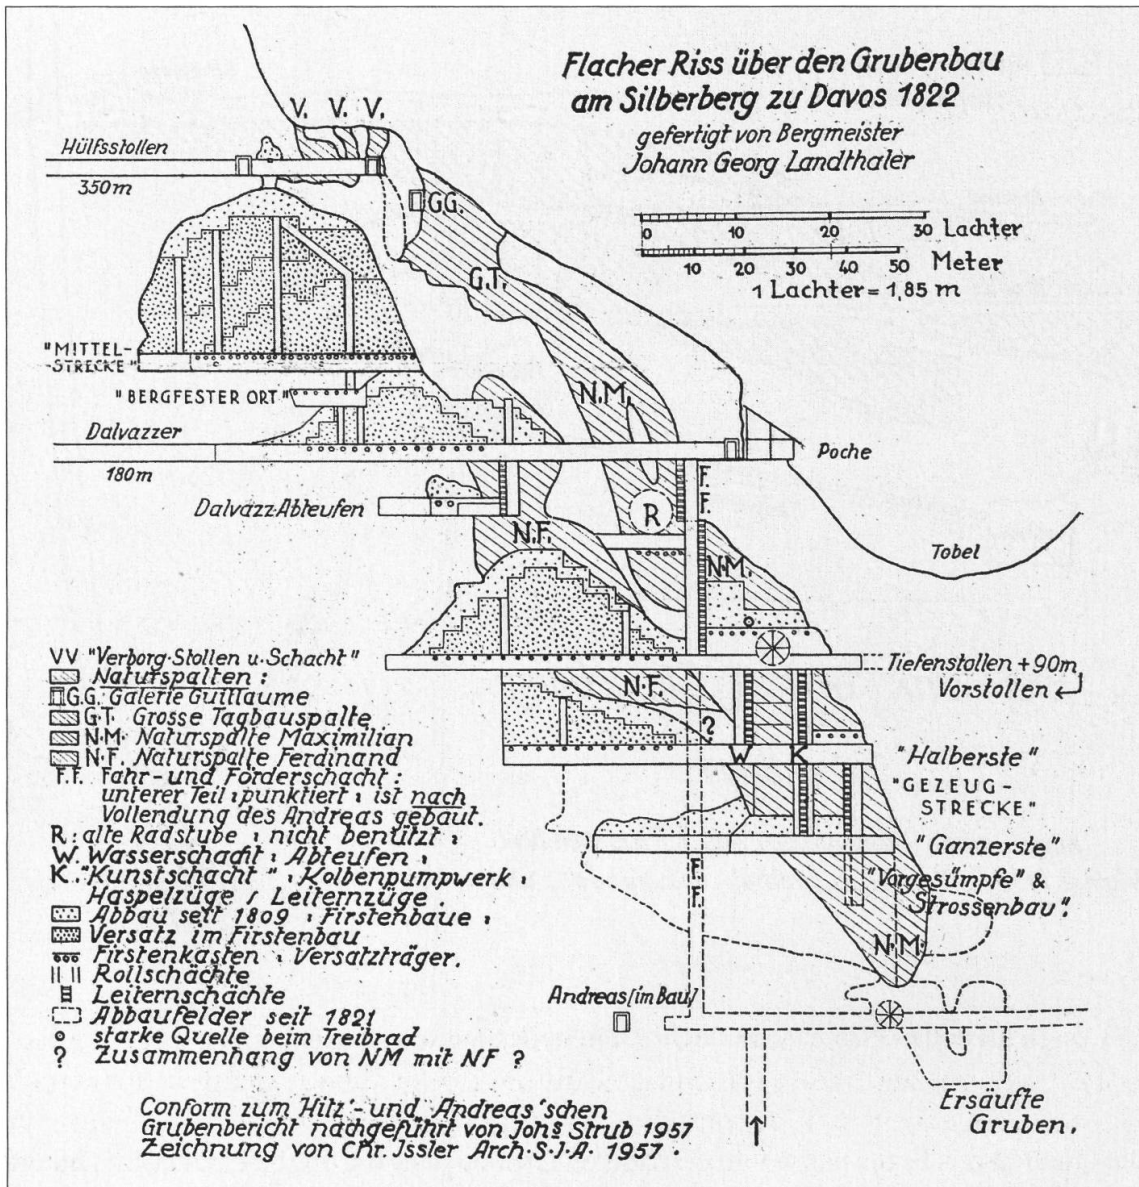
J. G. Landthaler 1822, Saigerriss mit Ergänzungen von Strub und Issler.
